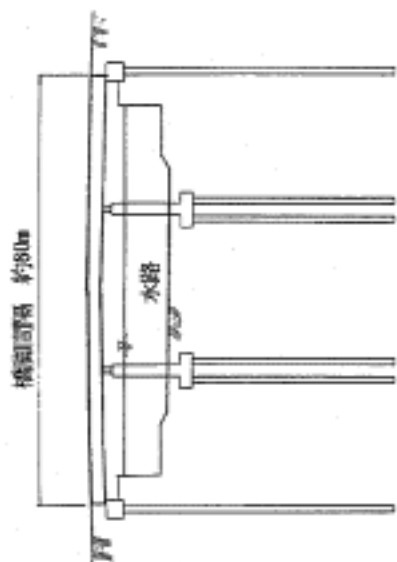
(3) 水路橋脚部橋梁全体断面図
